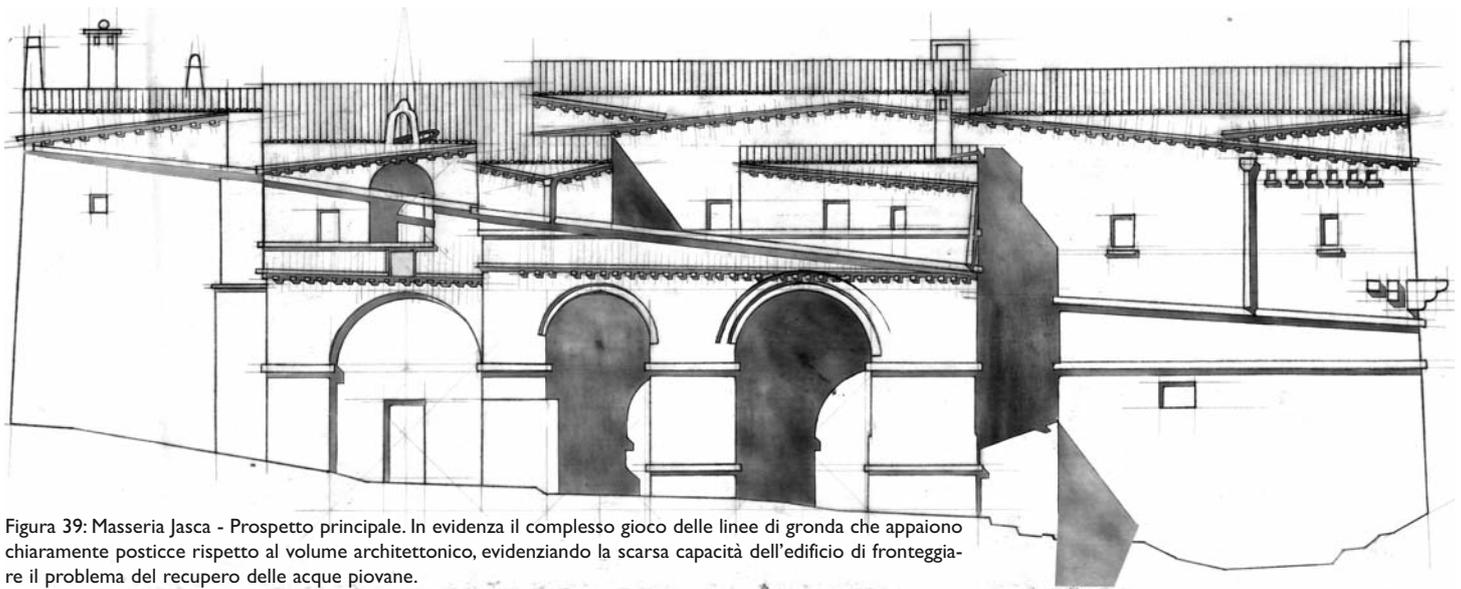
Masseria Jasca - Prospetto principale. In evidenza il complesso gioco delle linee di gronda che appaiono chiaramente posticce rispetto al volume architettonico, evidenziando la scarsa capacità dell'edificio di fronteggiare il problema del recupero delle acque piovane.
